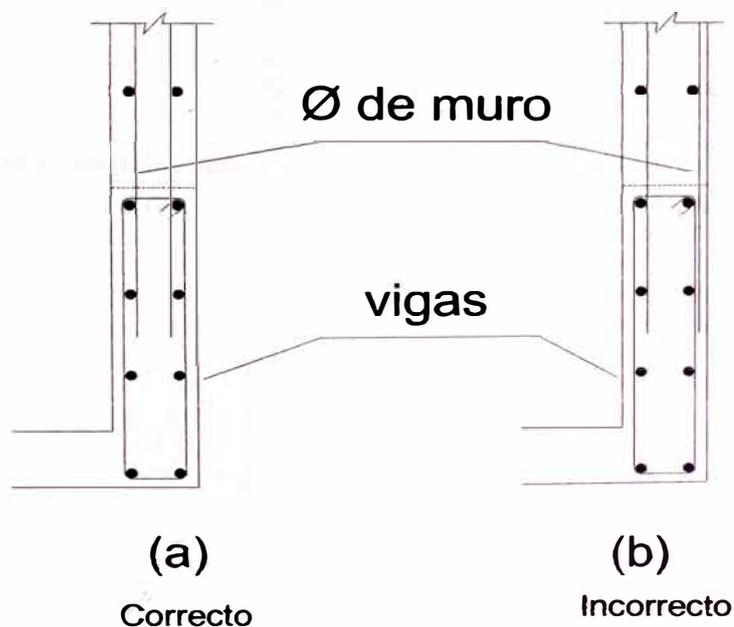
En (a) se muestra el correcto anclaje del acero del muro. En (b) se observa el anclaje (de 40 cm.) mal colocado, puesto que esta fuera de la viga, en el recubrimiento.
